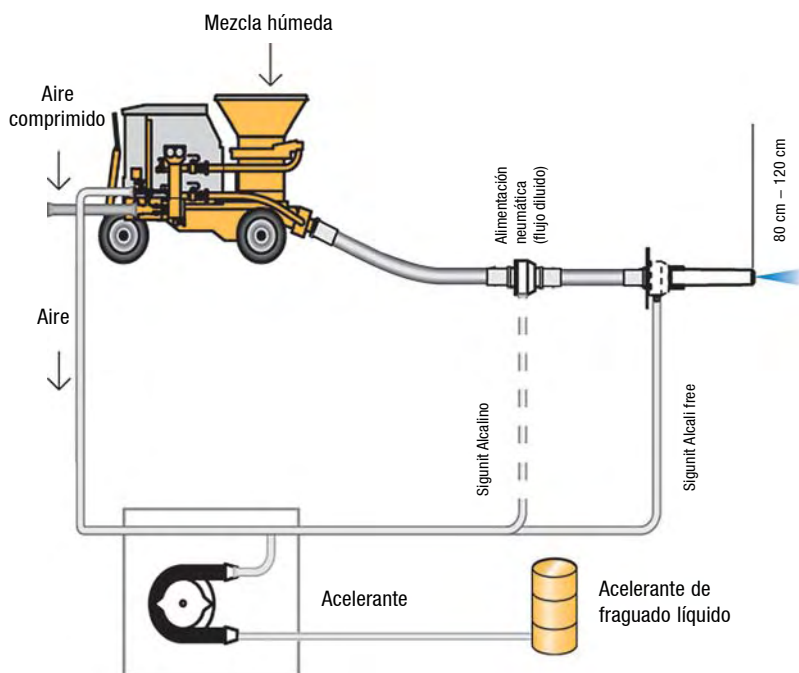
Concreto proyectado vía húmeda flujo diluido.
